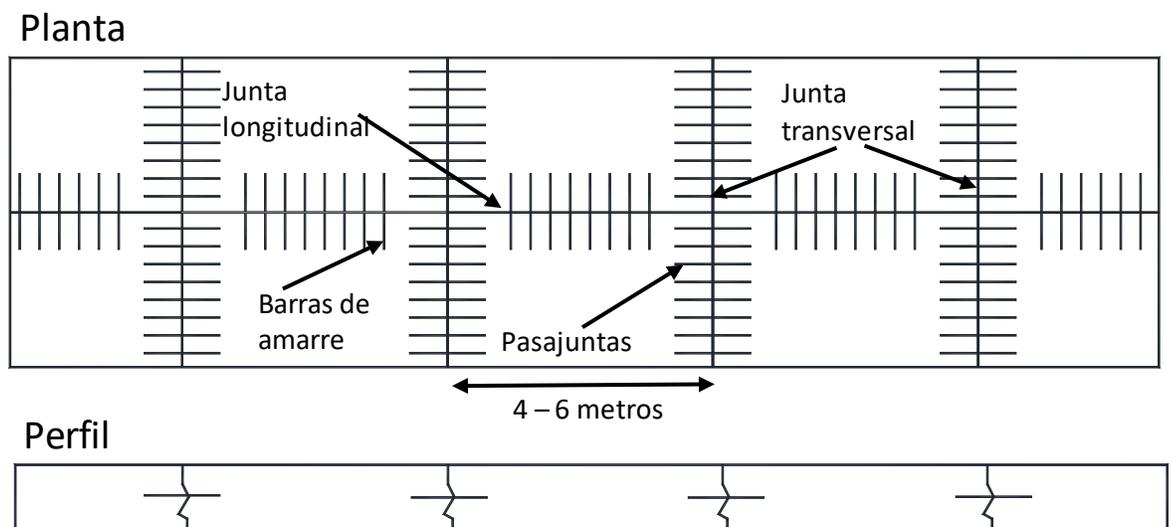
Pavimento de Concreto con Pasajuntas.(Elaboración propia).
